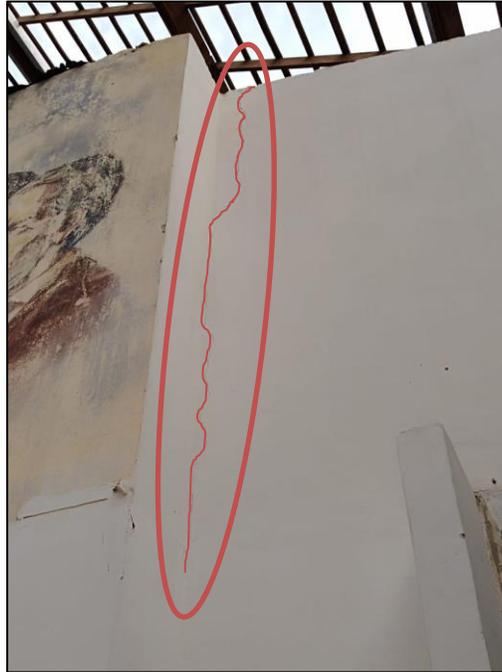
Muros fisurados del bloque B5 – Galería
